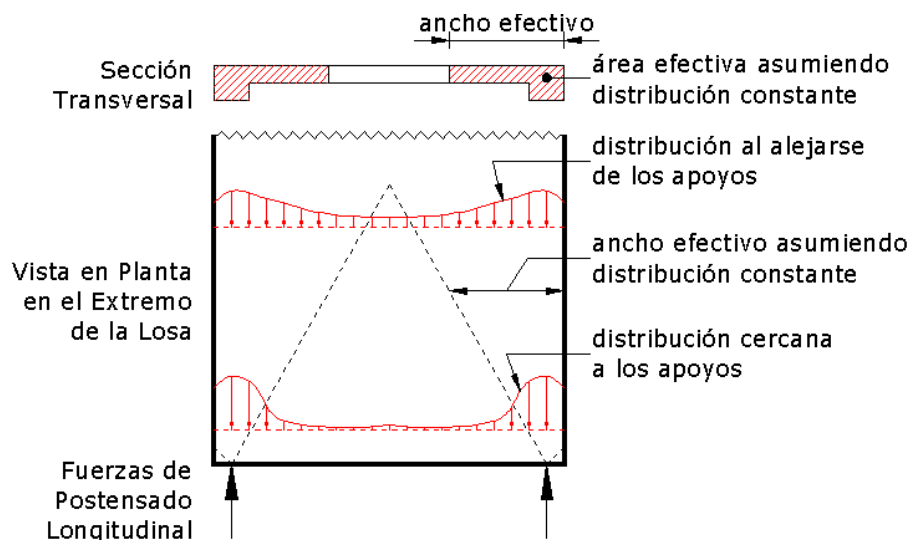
Distribución transversal de los esfuerzos longitudinales en la losa
